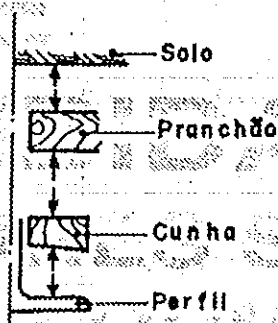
Maneiras de se instalar o pranchão em escoramento tipo Berlinense (Perfil metálico-pranchão)
